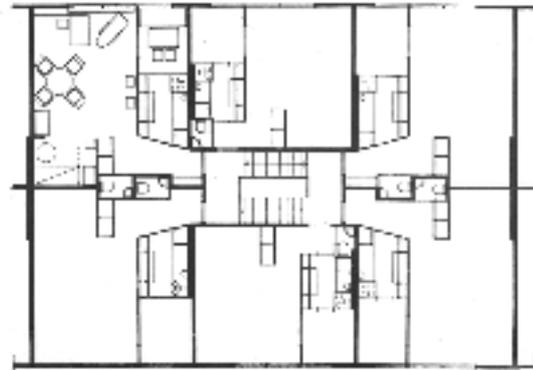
Sven Markelius: Grundriss eines Mietblocks der Siedlung Gräset im Süden Stockholms 1929-30.
